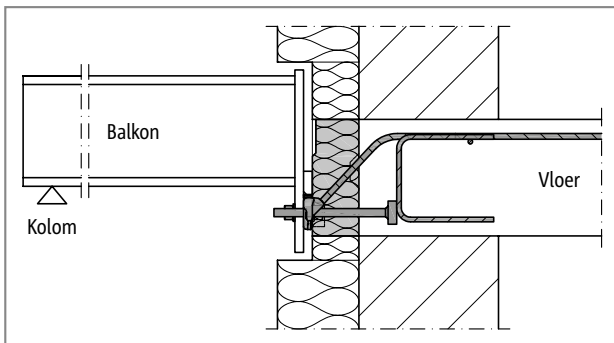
Schöck Isokorf® T type SQ: Balkon met puntvormige ondersteuning
